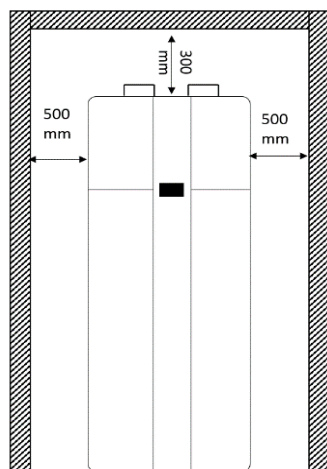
Distance minimale des murs pour les appareils sans conduits
